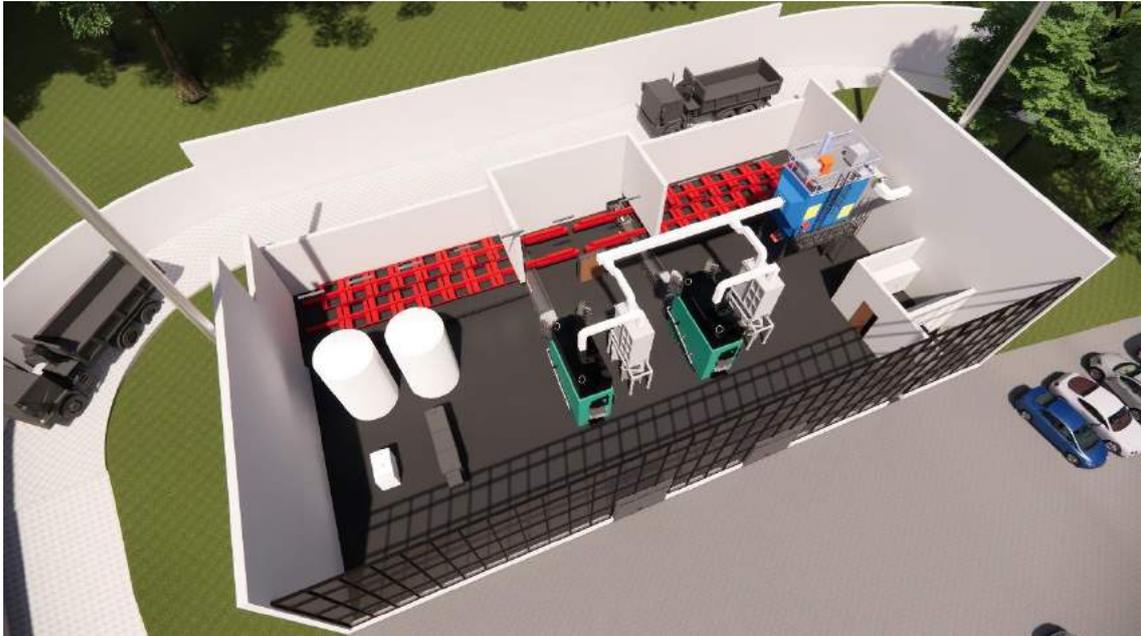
Grundriss der Heizzentrale – Innenwände ausgeblendet
